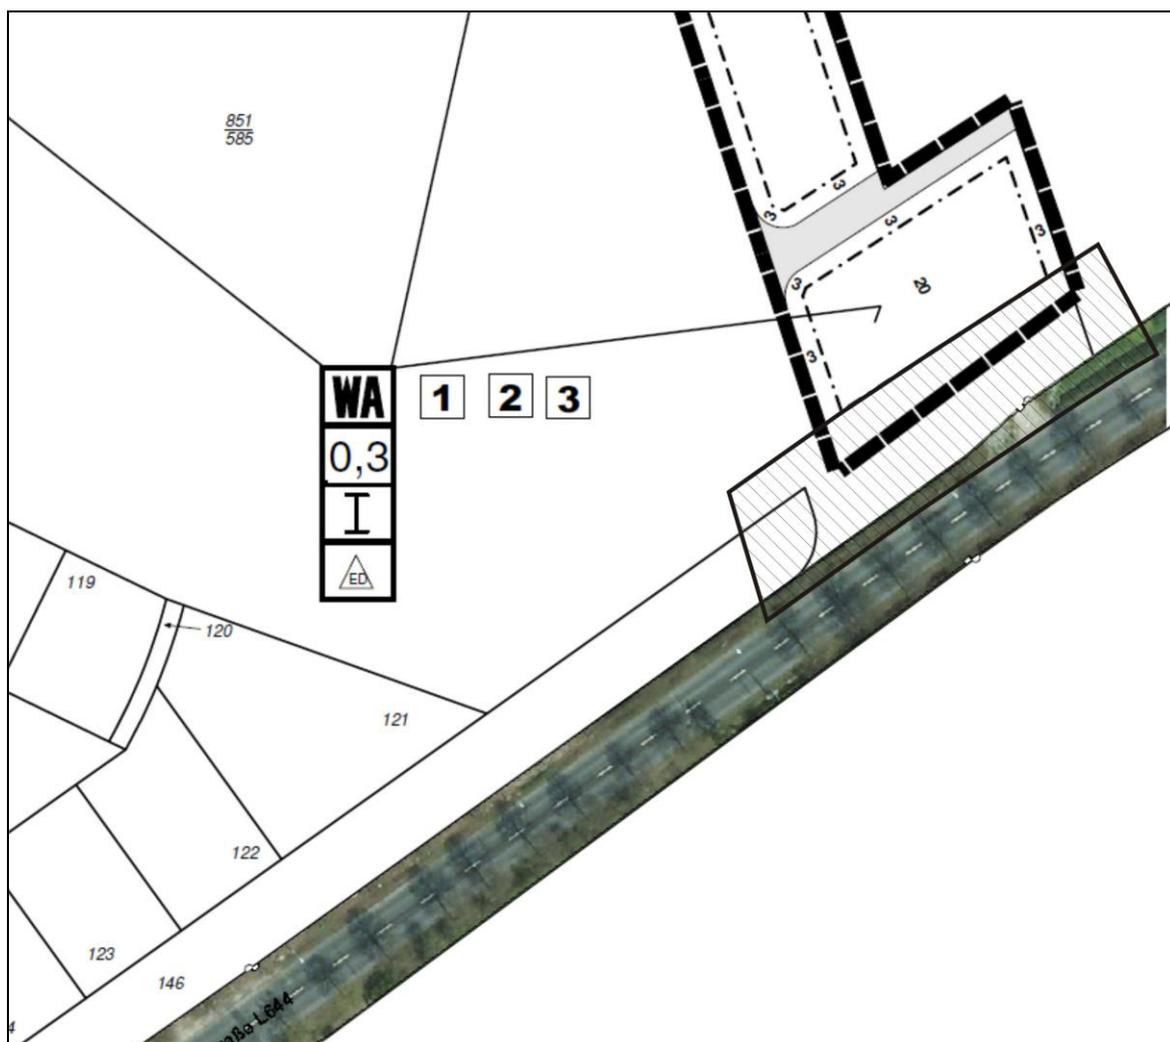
Planzeichnung B-Plan Nr. C 346, Luftbildaufnahme Memelstraße (Stand 2011), 20m-Bauverbotszone (schraffierte Fläche) im Bereich des Plangebietes
